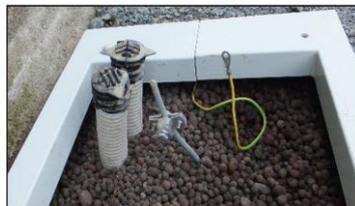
Rundstahlerder Ø8mm endet oberhalb Erdssockel
